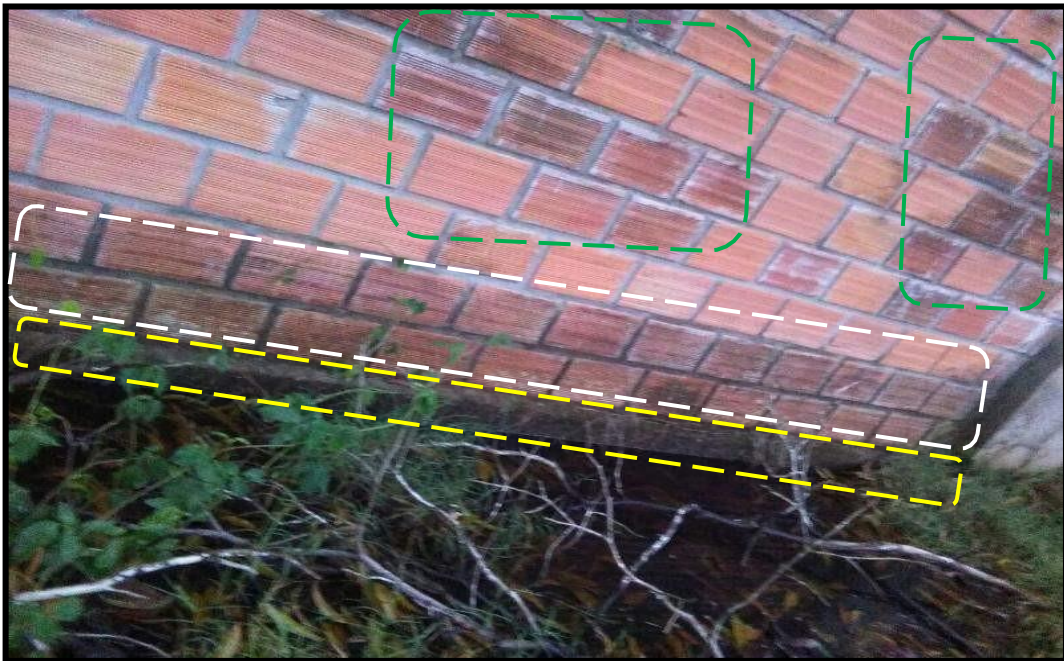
Se aprecia la eflorescencia y la humedad en muro y viga.
